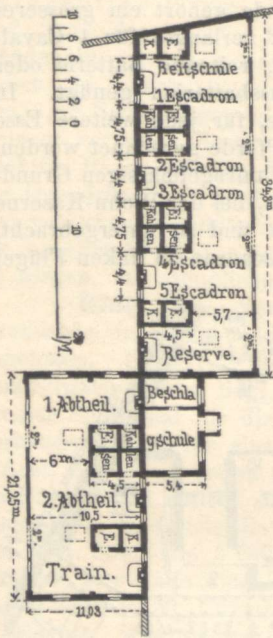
Grundriss der Hufbeschlagschmieden.
